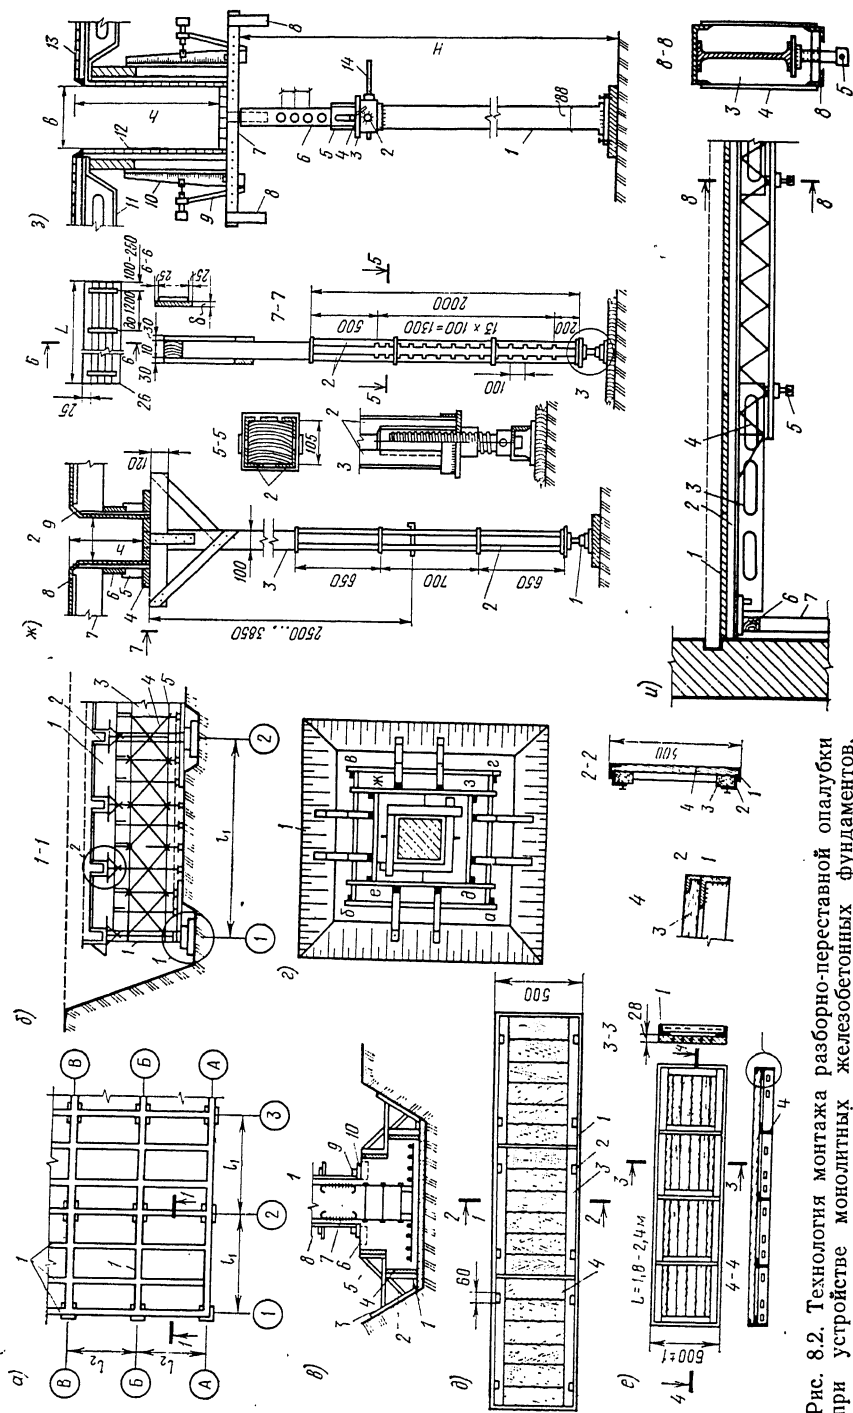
Технология монтажа разборно-переставной опалубки при устройстве монолитных железобетонных фундаментов, колонн и перекрытий
